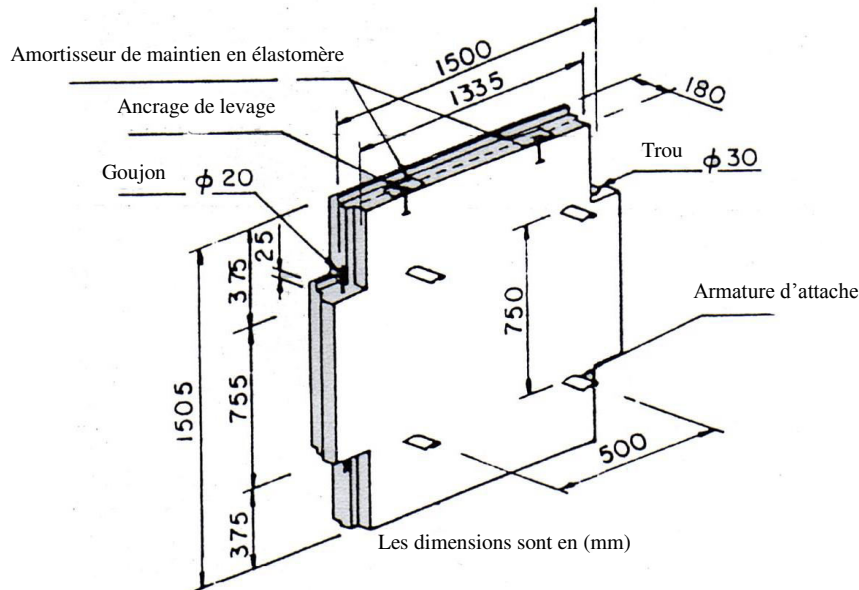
Choix des épaisseurs d'écailles en béton constituant le parement.
